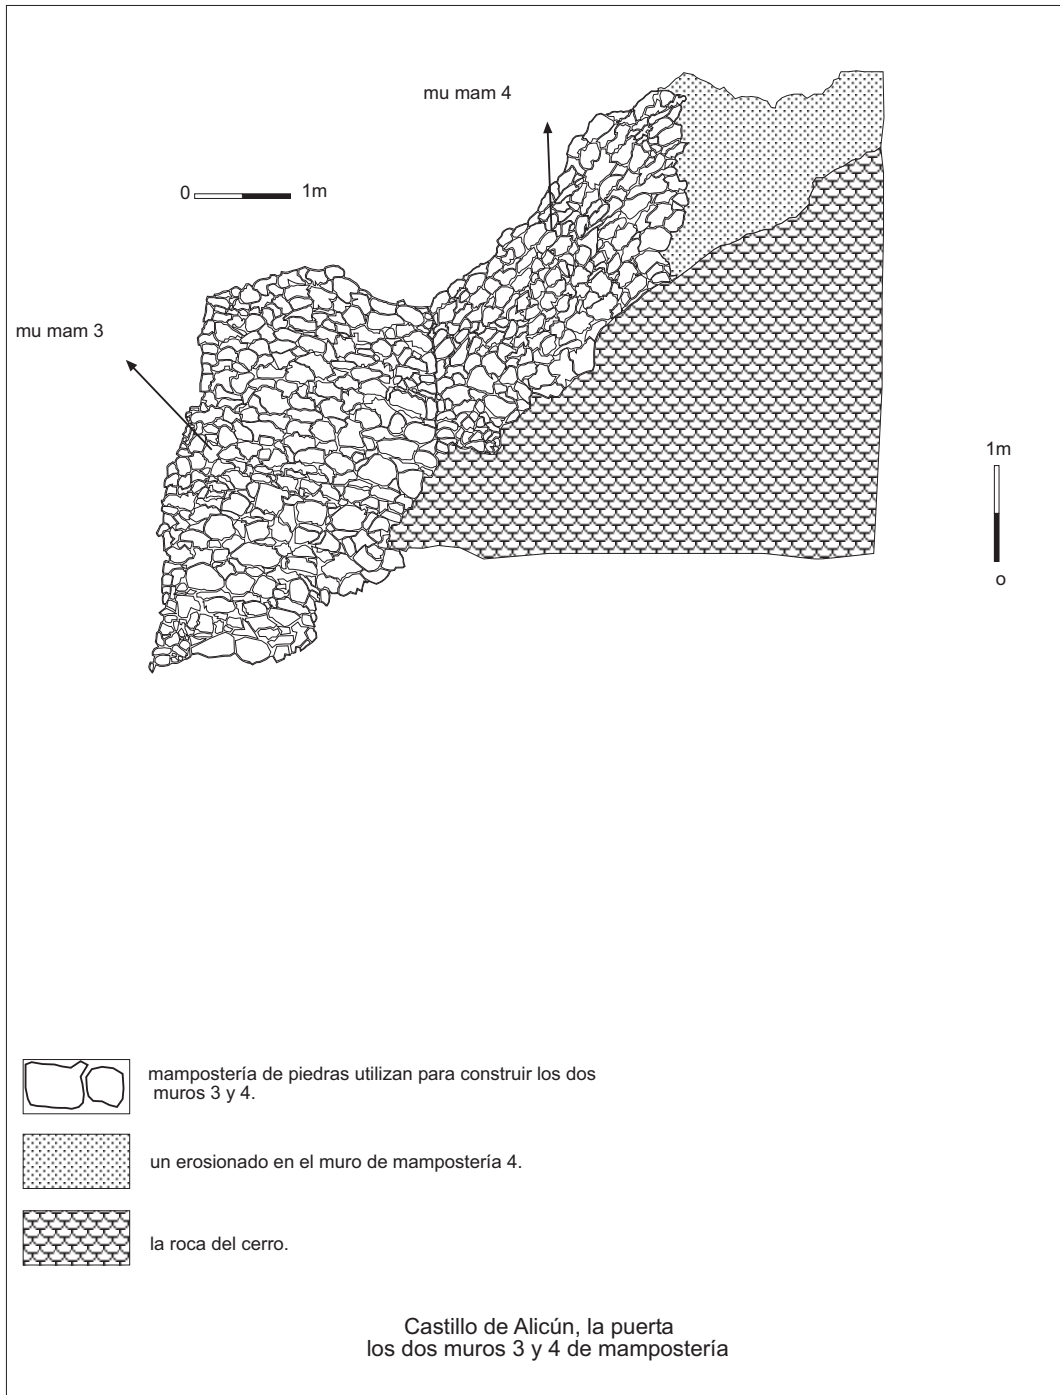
Castillo de Alicún, muro mampostería 3 y muro mampostería 4 de la puerta en sus caras N.
